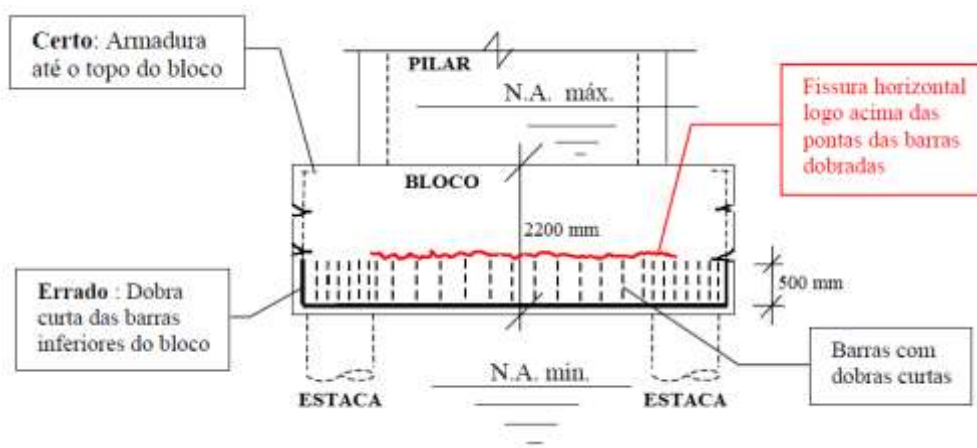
Bloco sobre estacas fissurado com detalhamento da armadura de flexão
